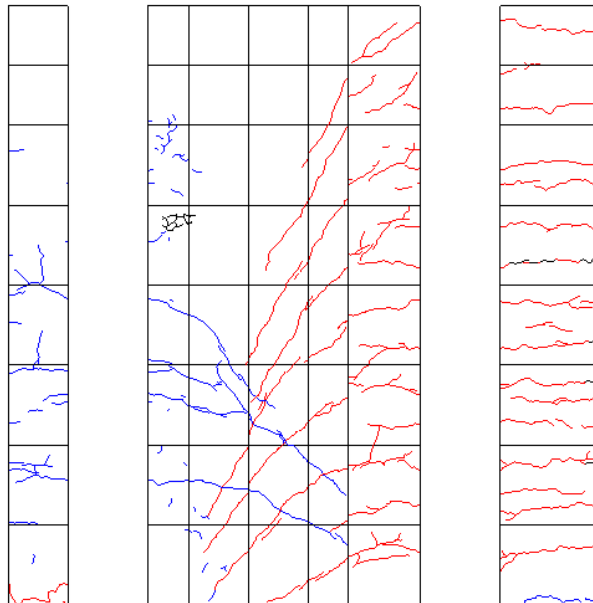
R=-1/67 ひび割れ図
